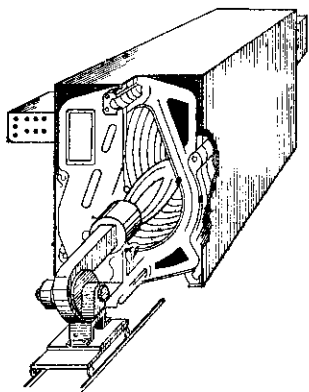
Чугунный котлоагрегат «Факел» (общий вид)
